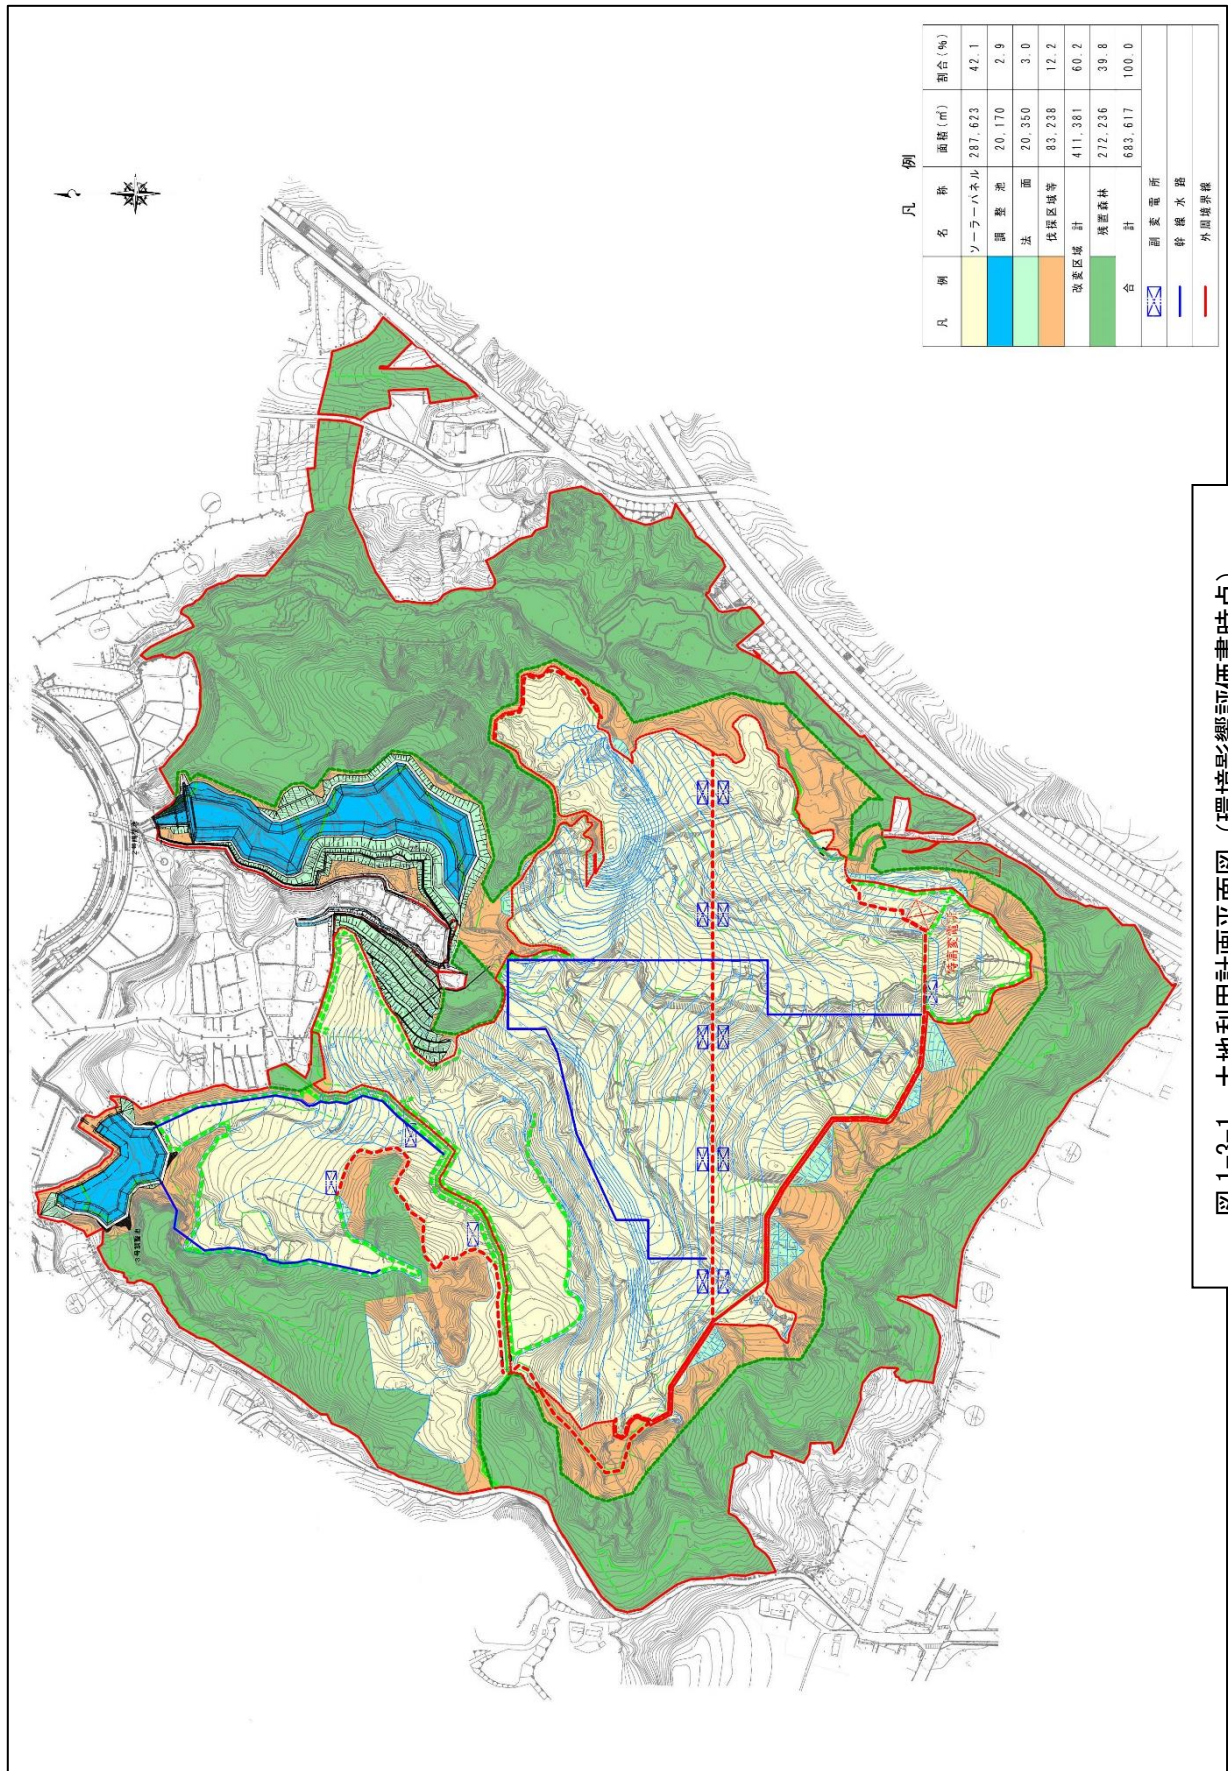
土地利用計画平面図 (環境影響評価書時点)
